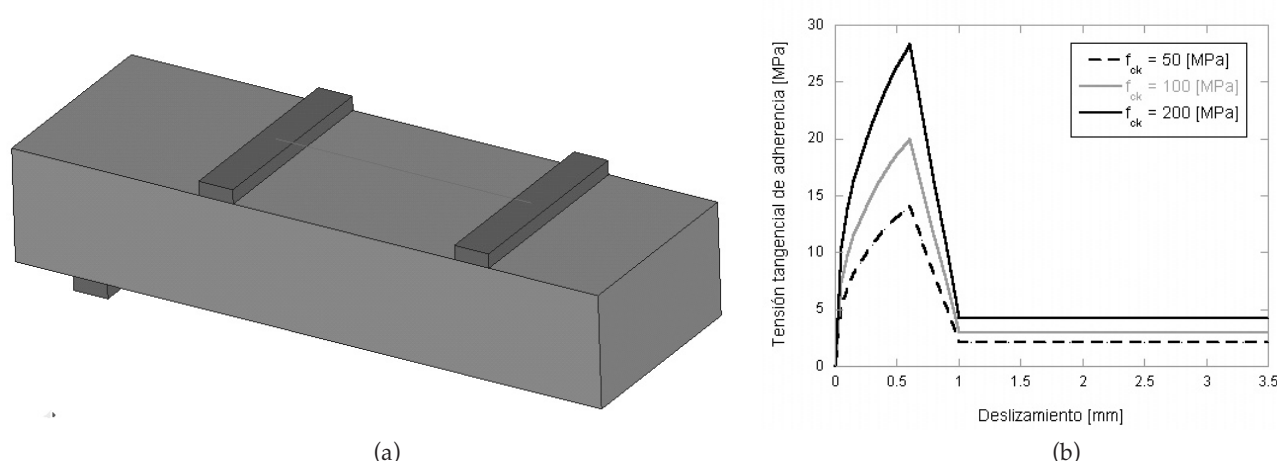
(a) Vista del modelo 3D desarrollado, únicamente para la mitad de la viga debido a la simetría existente.
